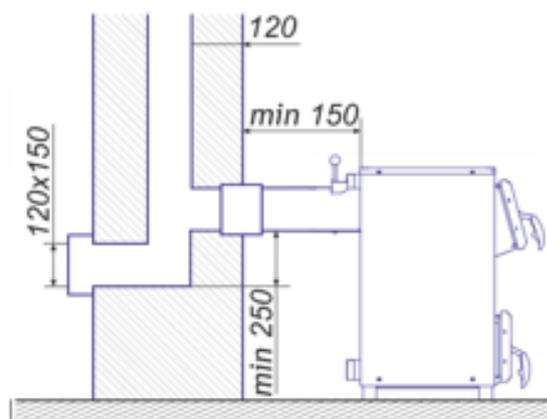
а – Устройство саже сборника и ревизионного окна при расположении дымохода в шахте (вид сбоку)
